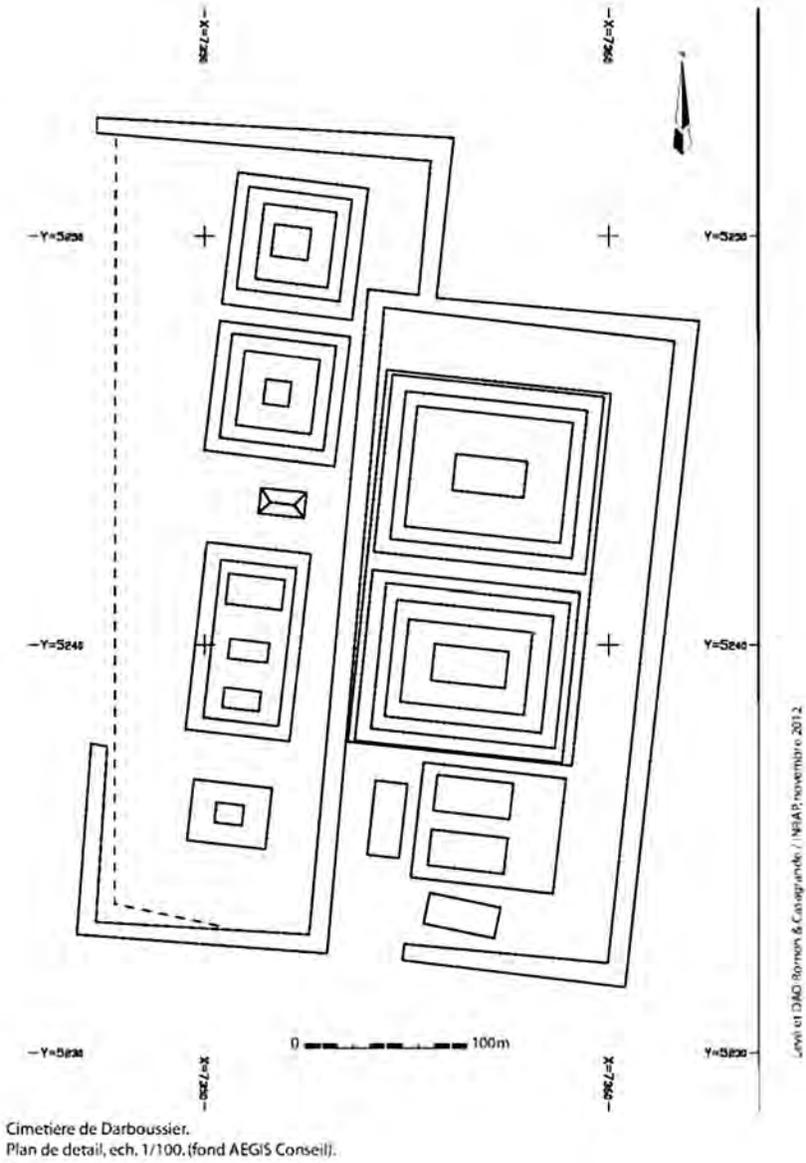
Cimetière de Darboussier, plan de détail.
